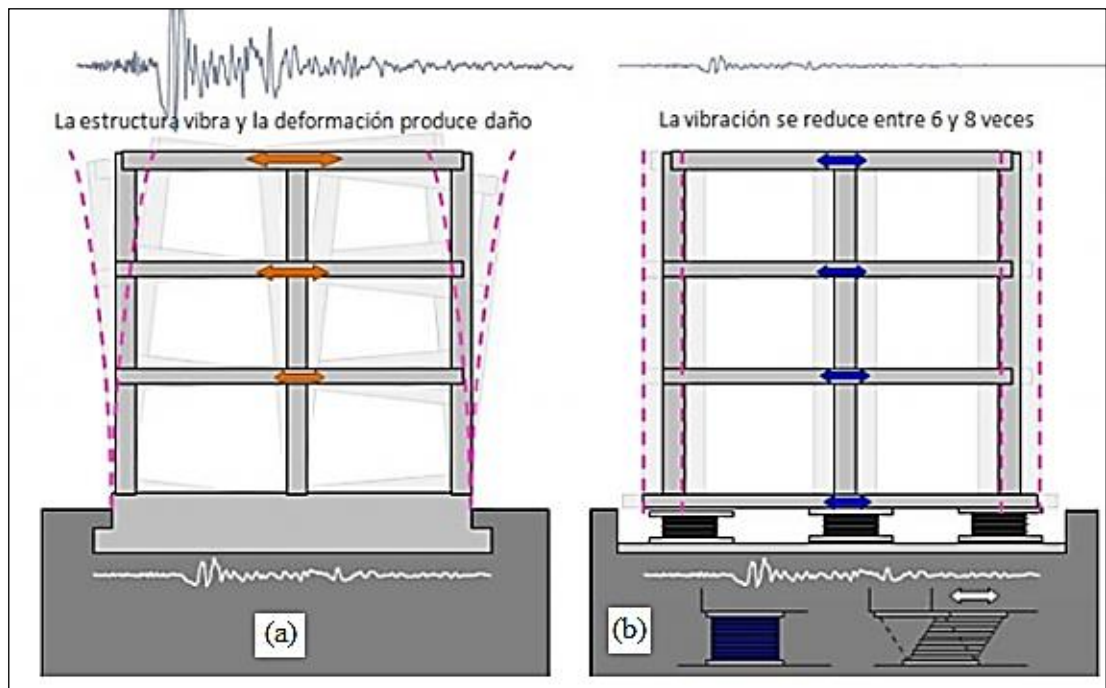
(a) Estructura de base fija, (b) Estructura aislamiento en la base [17].
